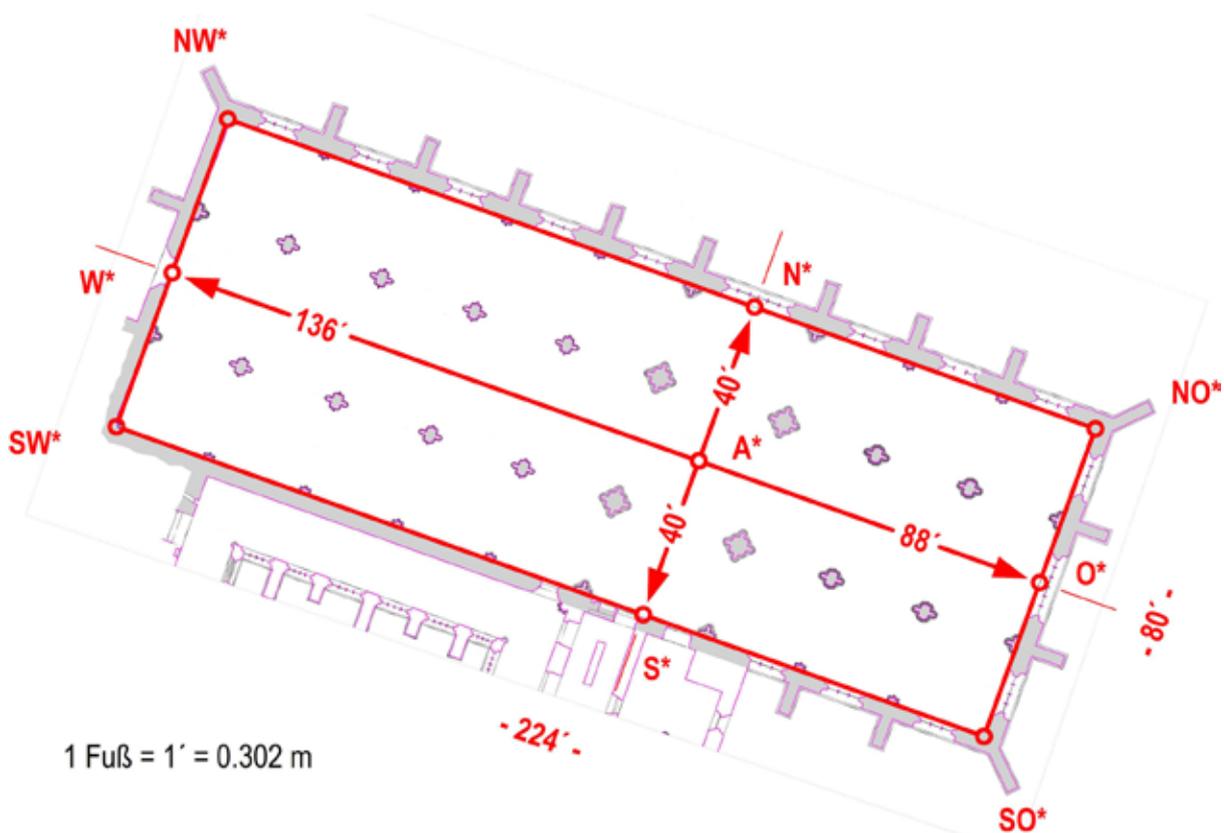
Münster Neuberg, Abweichungen zwischen Planung und Ausführung in stark übertriebener Darstellung (Abweichungen gegenüber Maßstab Grundriss 30-fach vergrößert).
